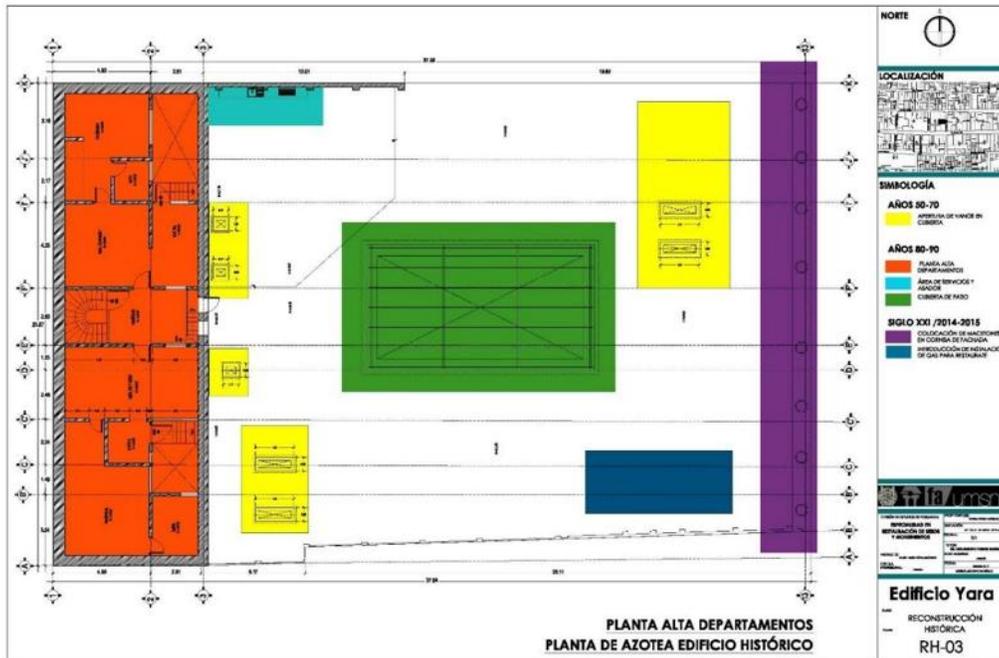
Plano de Reconstrucción Histórica Años 50-90 / Siglo XXI
